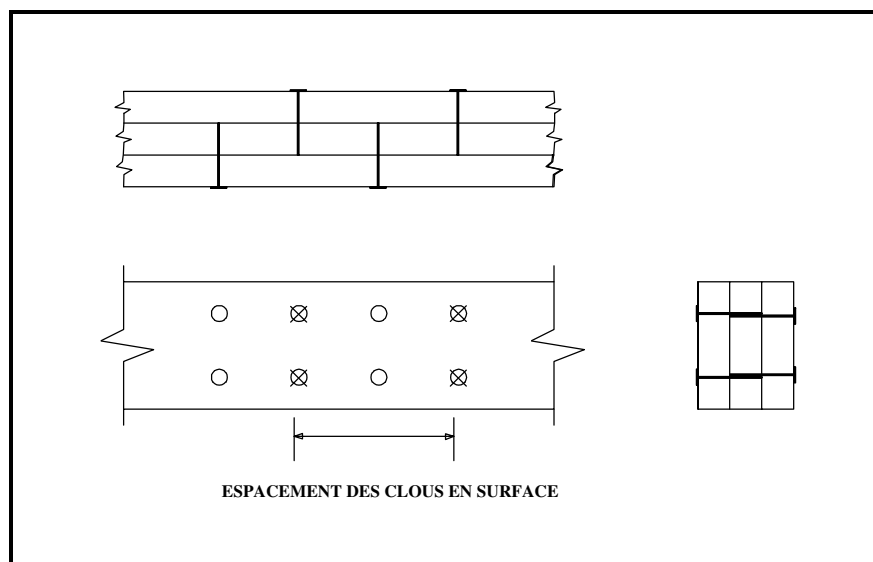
Disposition des clous pour ferme maîtresse à 2 plis
